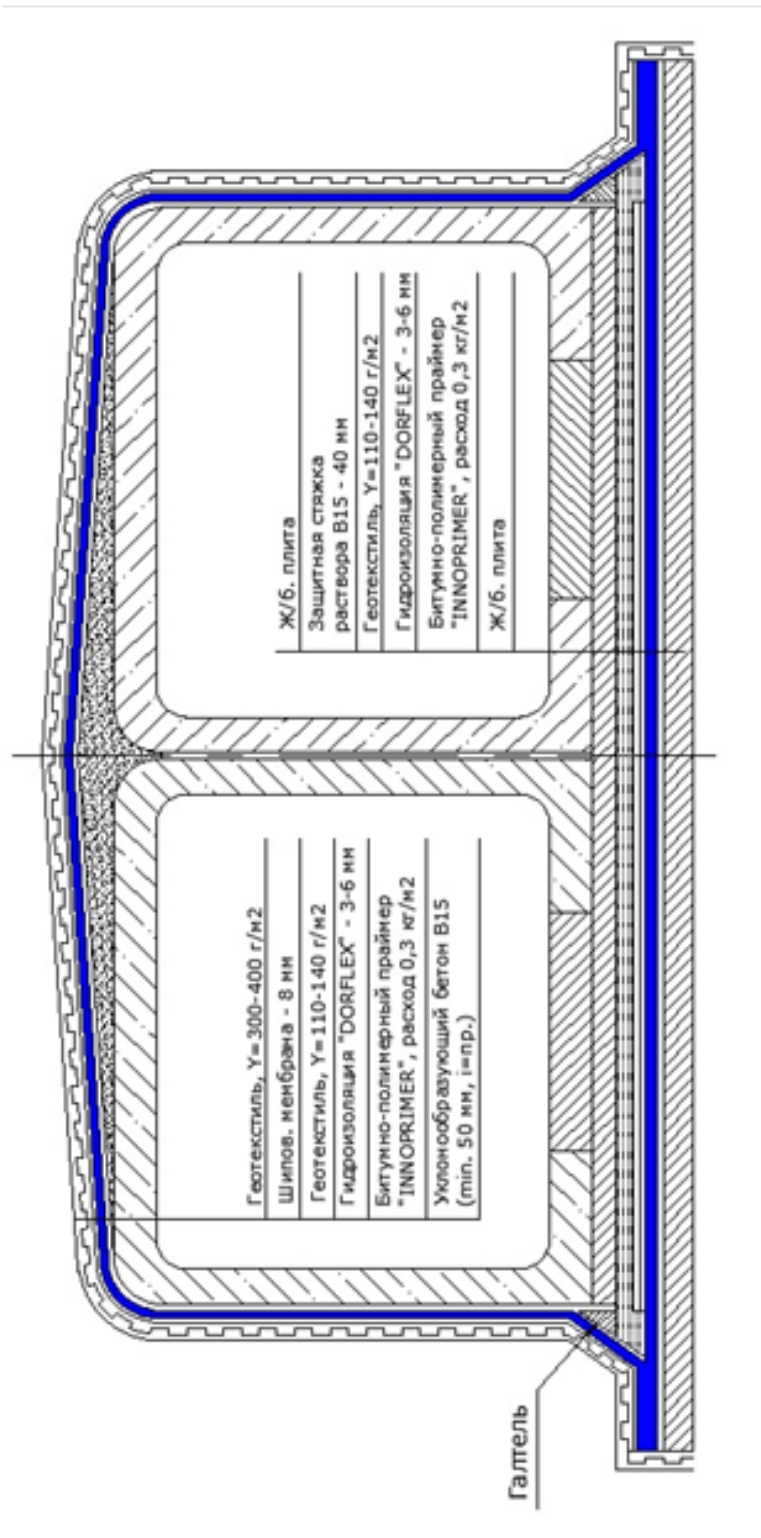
Внешняя гидроизоляция тоннеля.
